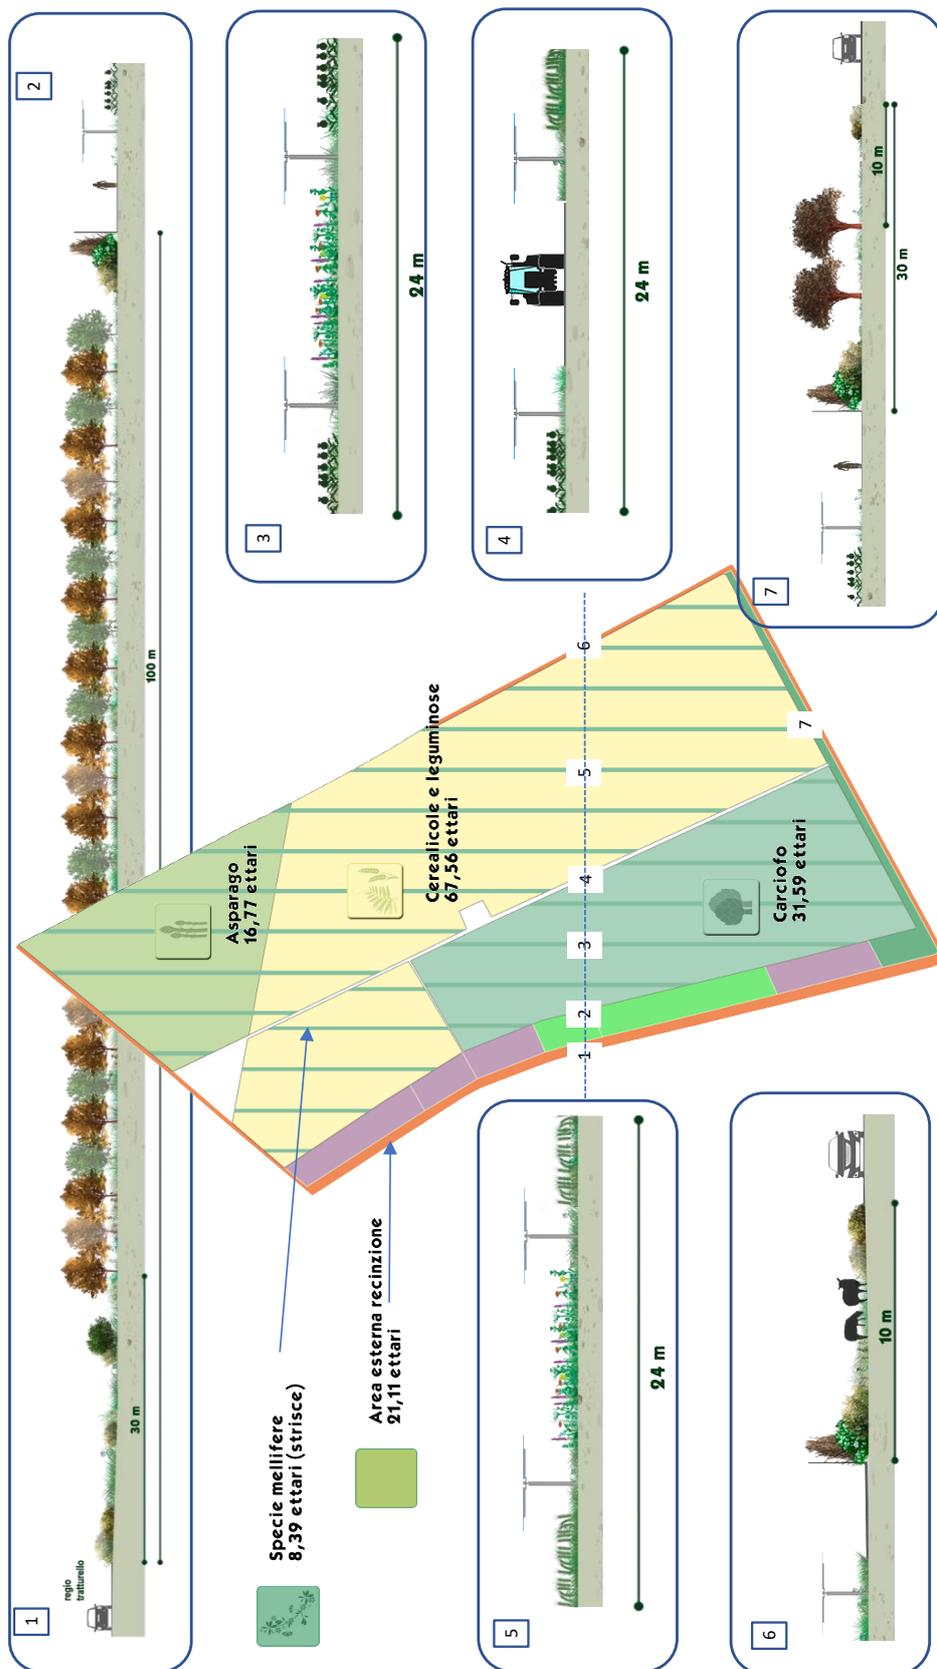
Planimetria generale dell'impianto ANaV e sezioni di dettaglio delle colture, della fascia di rispetto e dell'habitat 6220.
